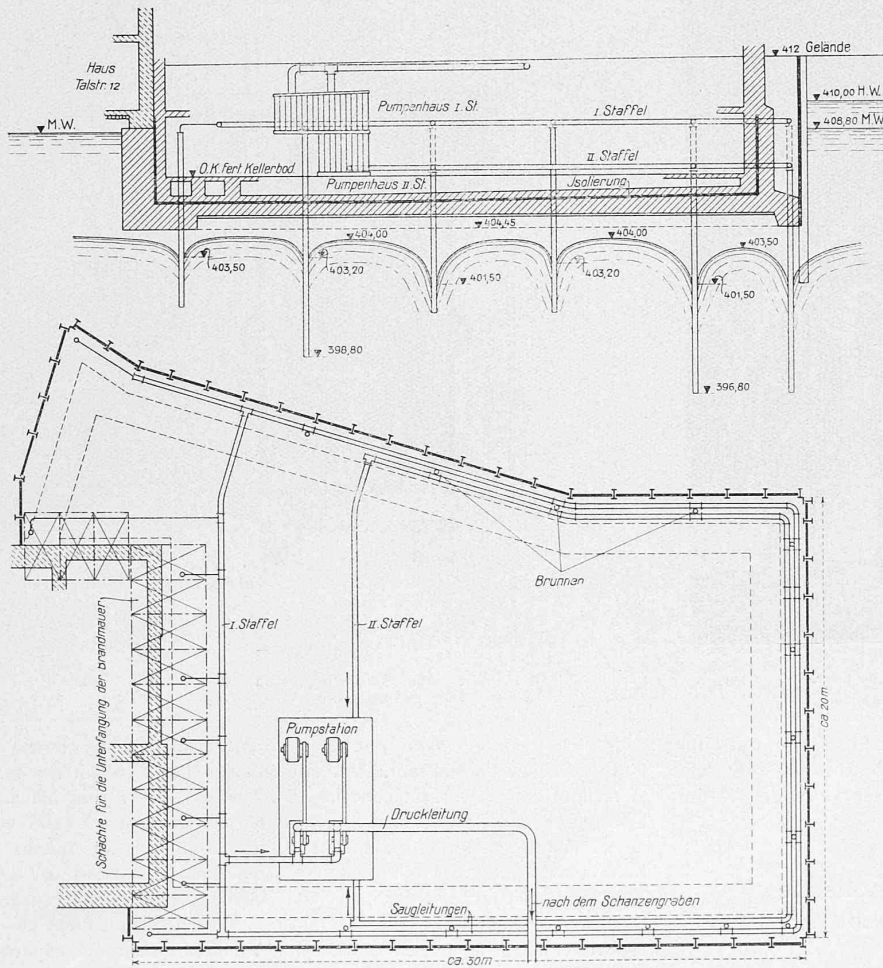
Grundriss der Baugrube und Schnitt längs der Talstrasse. — 1:300.
